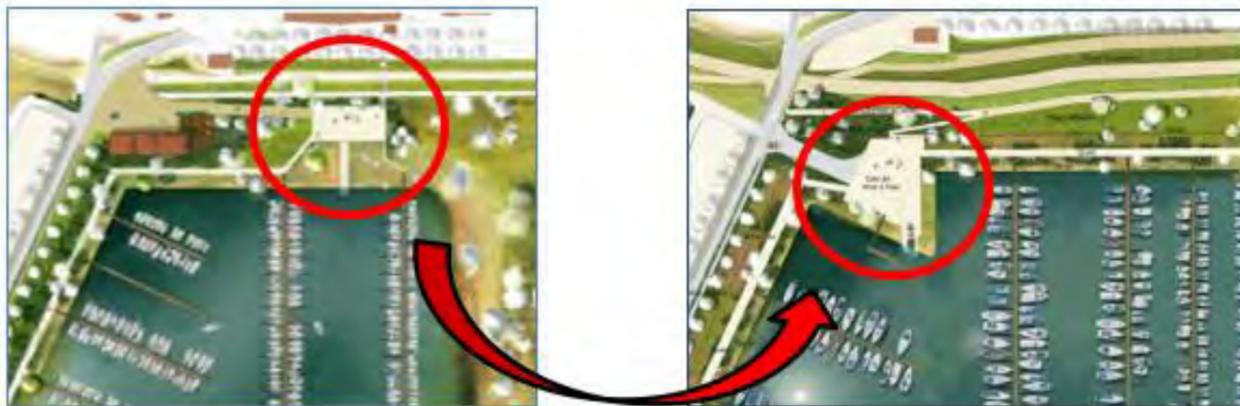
Plan paysager du projet au stade APS (solution n°1)
